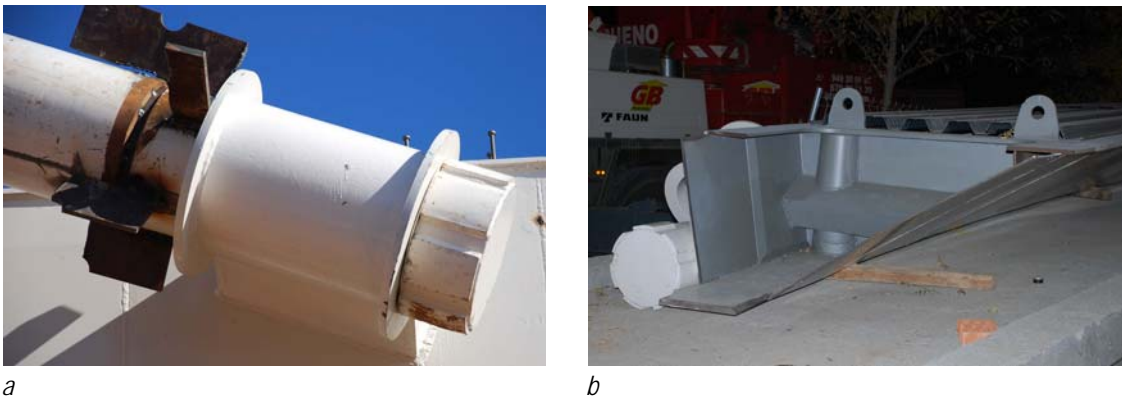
Unión del cordón superior de un ramal de acceso a la viga; a) Vista general durante la construcción; b) Vista interior de la viga cajón
